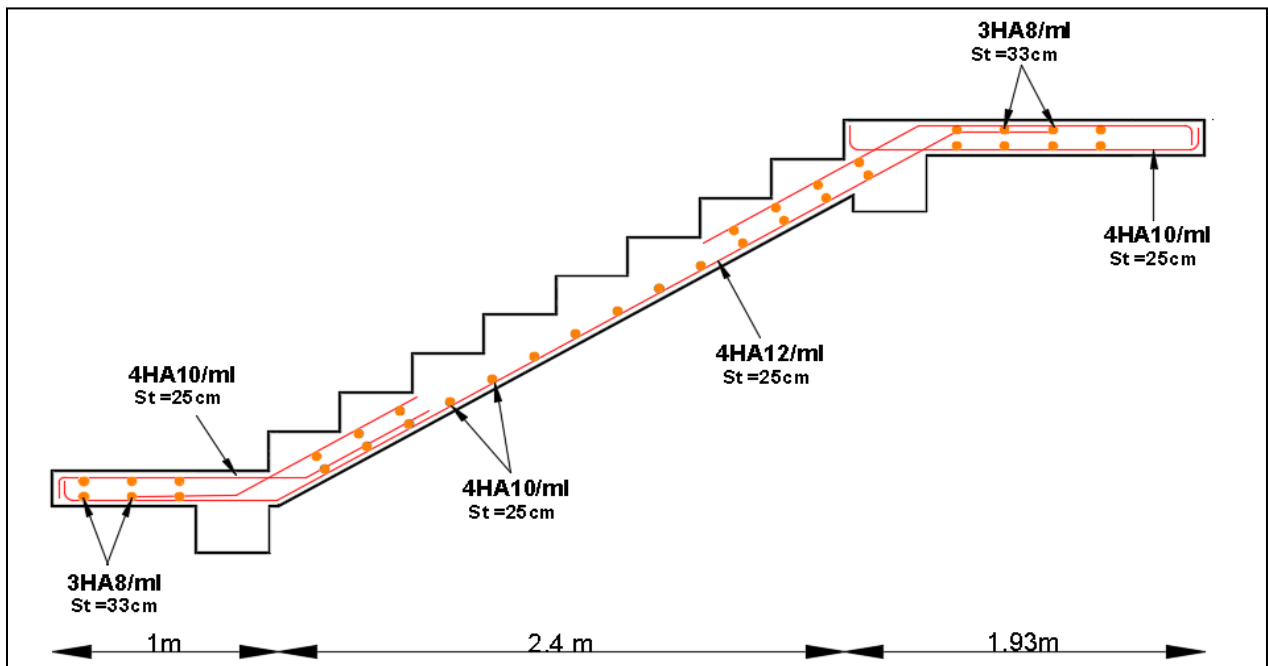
Schéma de ferrailage d'une volée 1 d'étage Type 1 .
